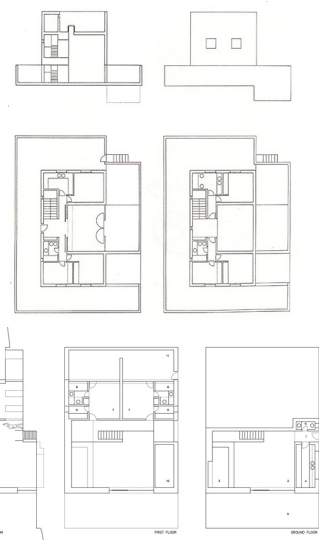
e 188 | Em cima, secção, alçado e plantas da casa García Marcos; em baixo, secção e plantas da casa Tomford, ambas projecto do Arqº Campo Baeza
